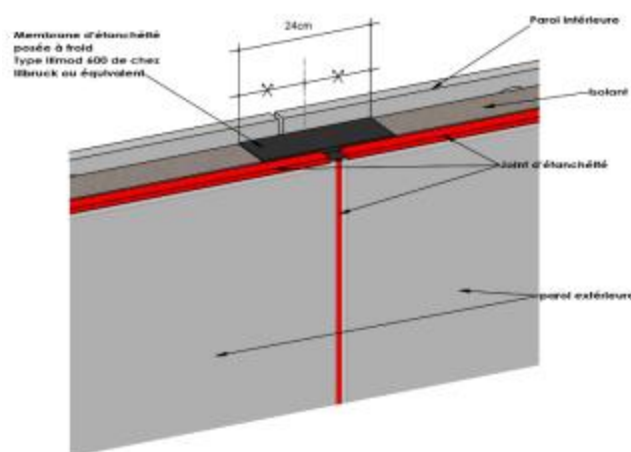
Détails sur joints horizontaux : paroi extérieure au niveau de l'arase supérieure du plancher
